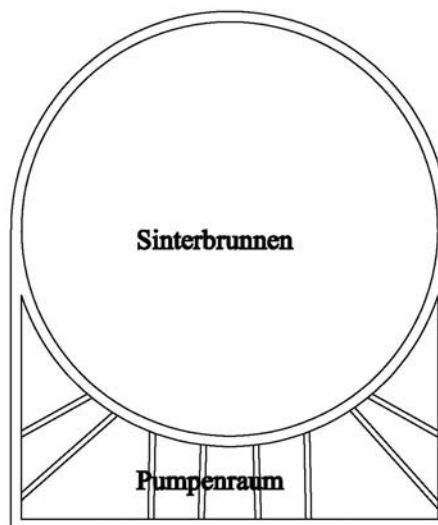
Grundriss Baugrube Sinterbrunnen und Pumpenraum
